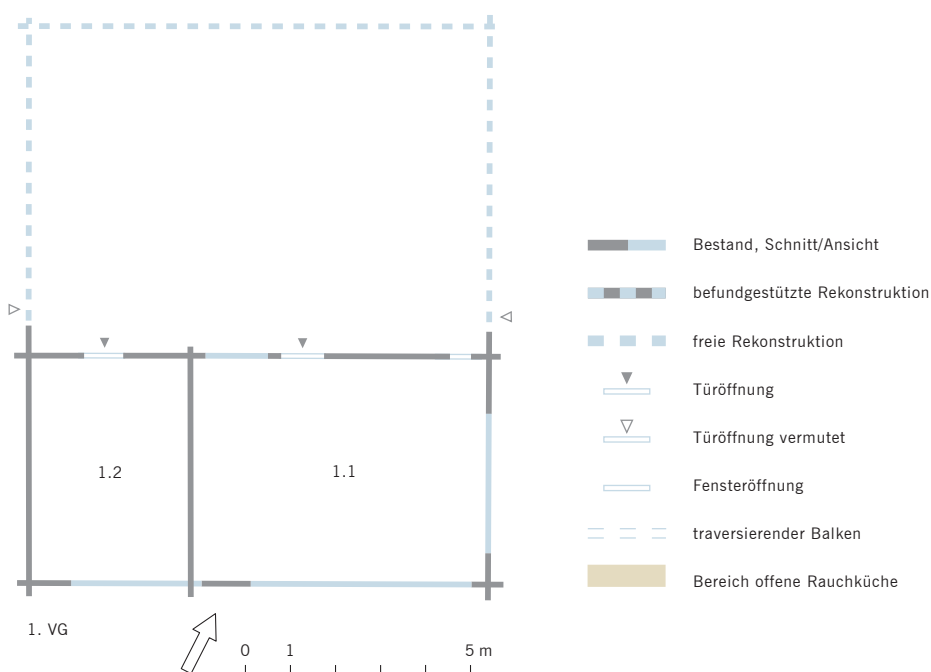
Haus Oberzittenbuch in Unterägeri, rekonstruierter Grundriss des ersten Vollgeschosses.
